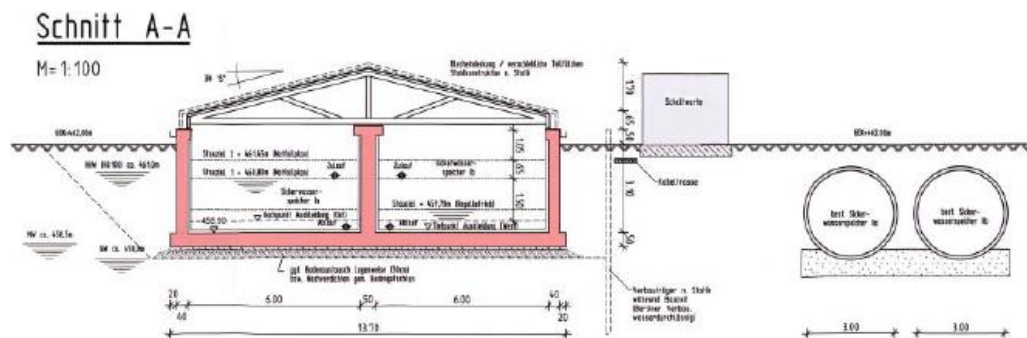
Schnittdarstellung Sickerwasserspeicherbecken Bestand (Quelle: Lageplan Bestand Sickerleitungen 2001)
